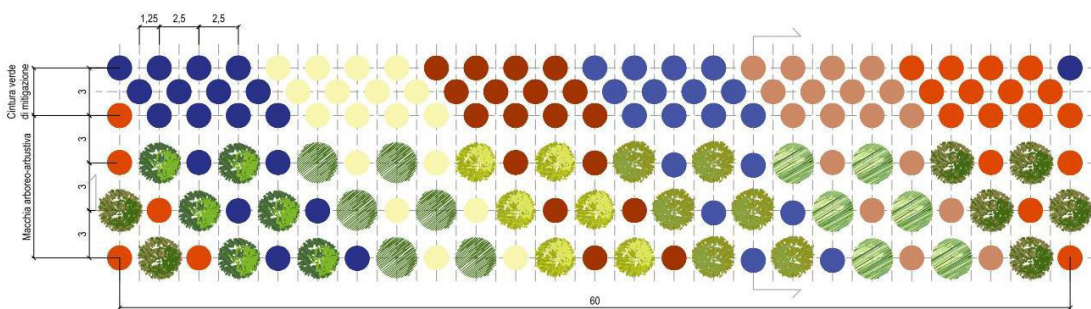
Sesto d'impianto e sezione tipologica
